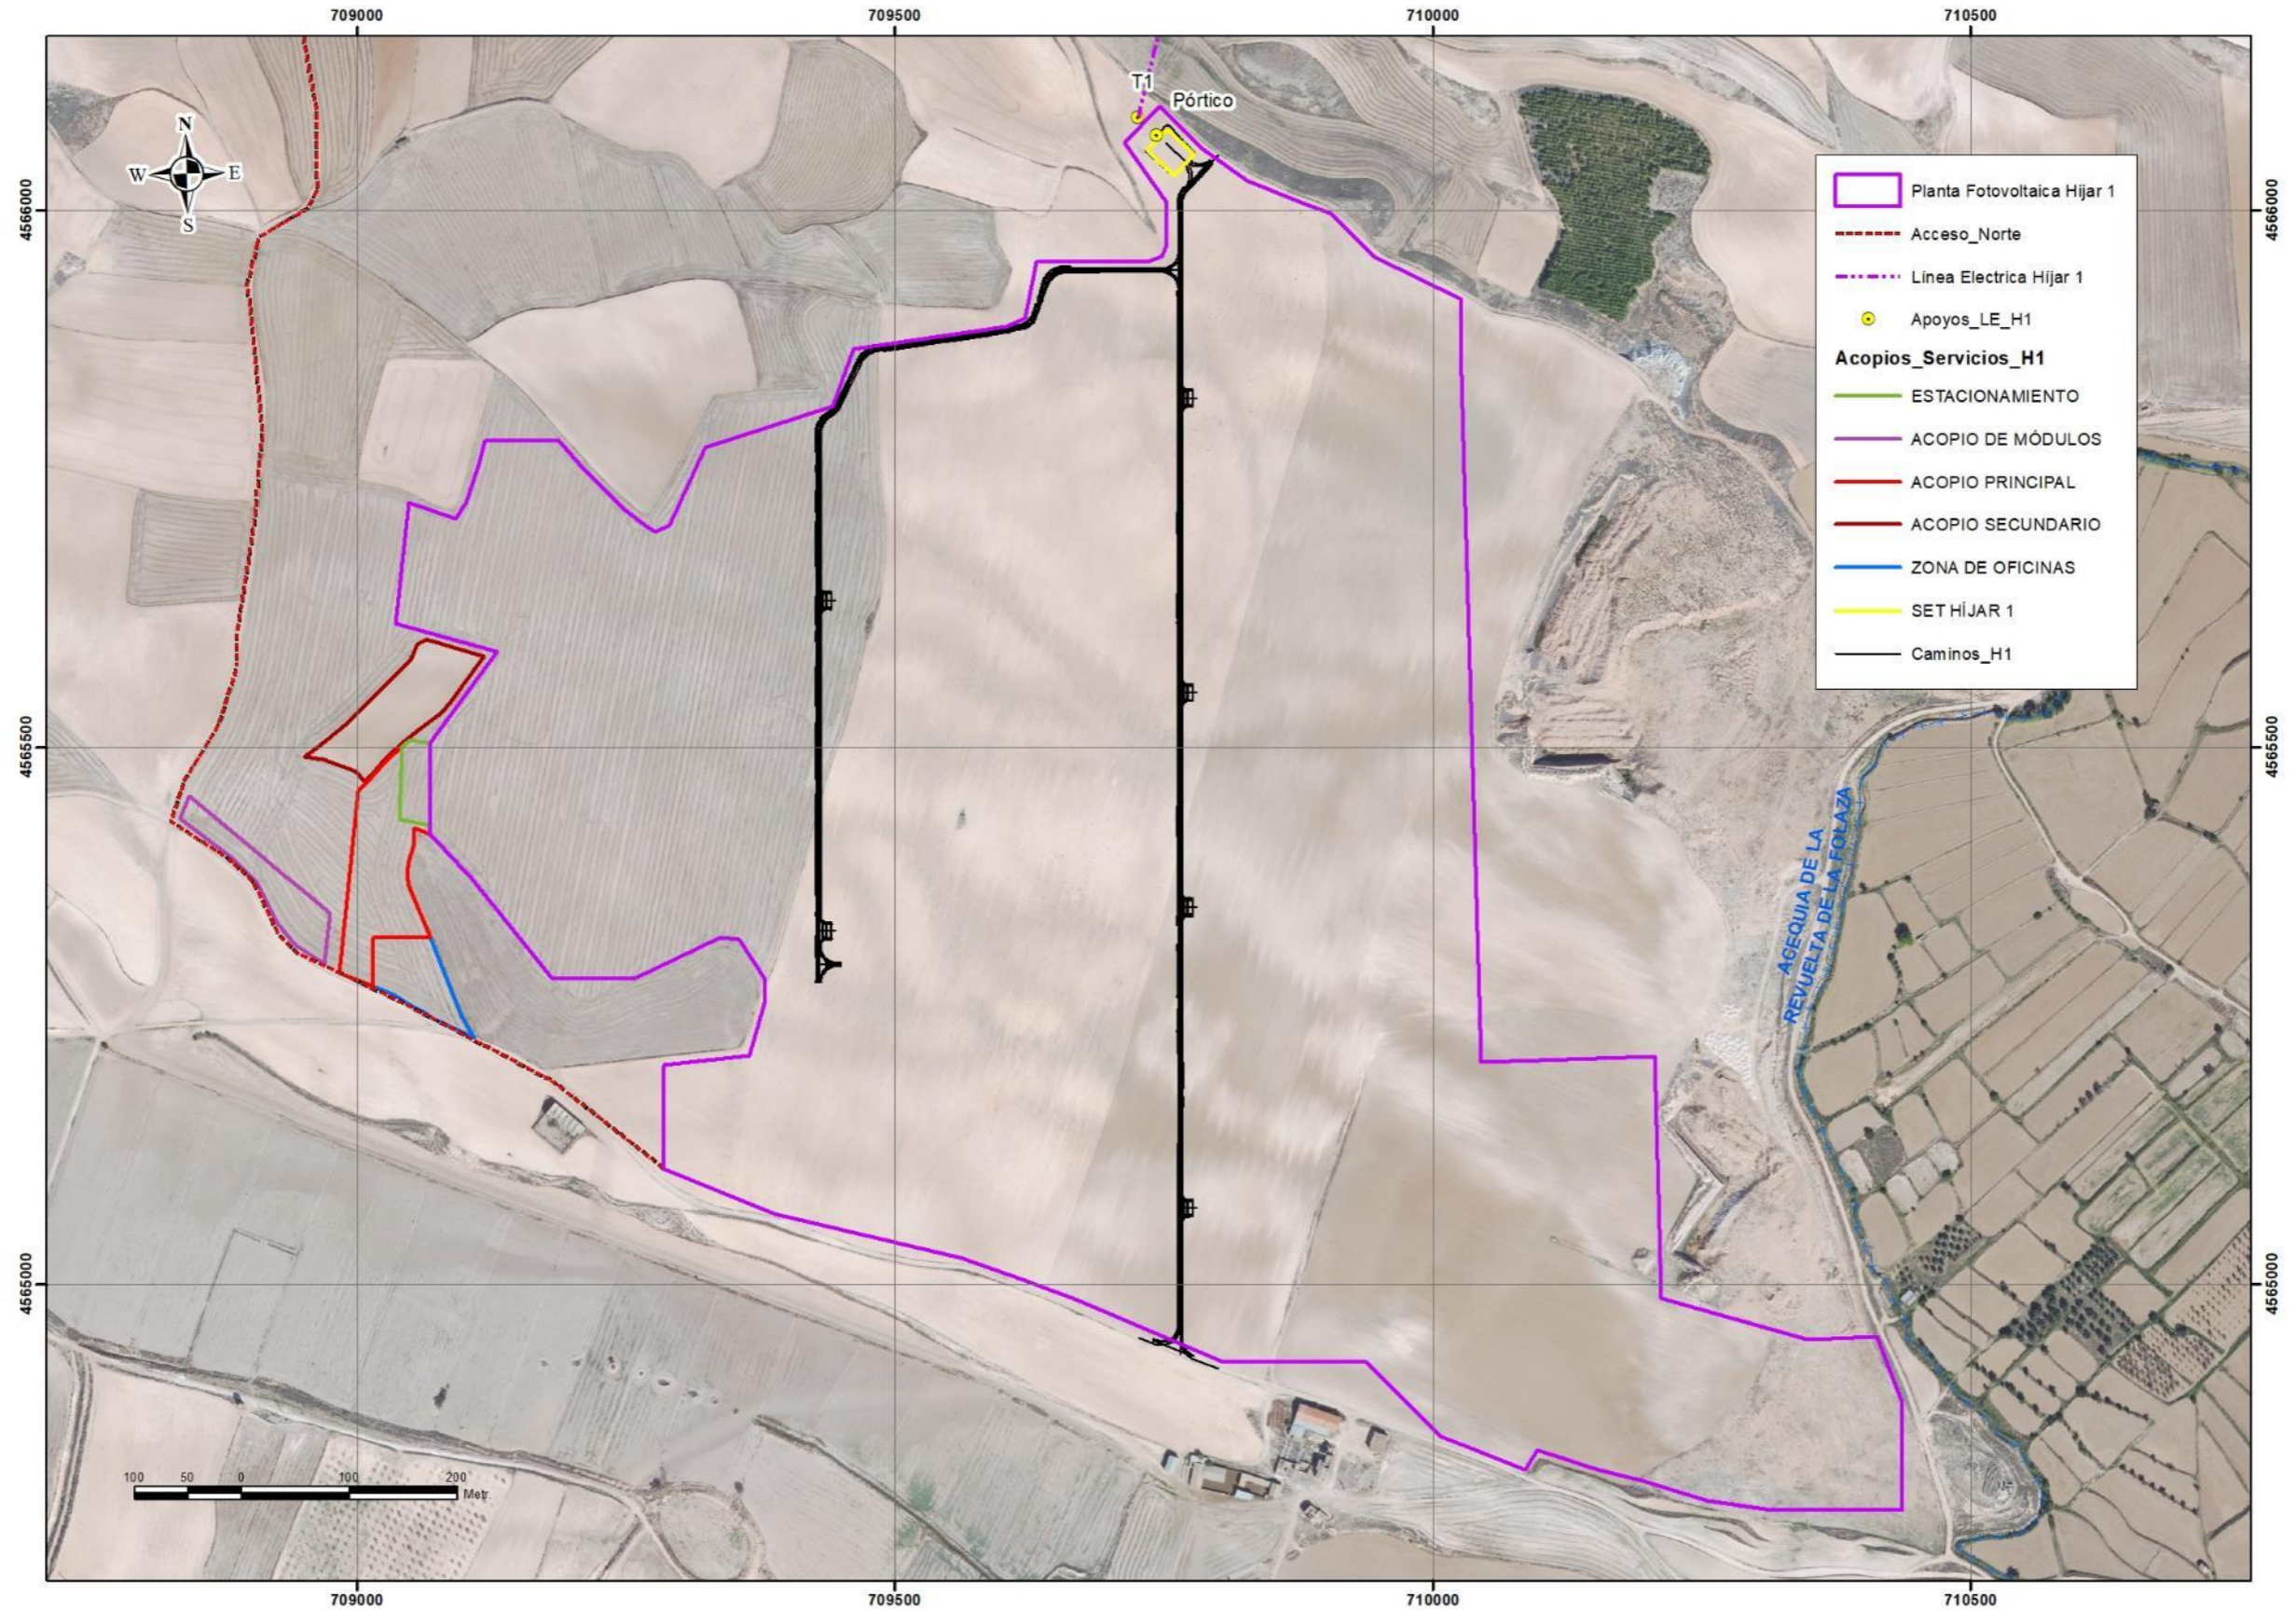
Zonas de afección planta fotovoltaica "Híjar 1".
